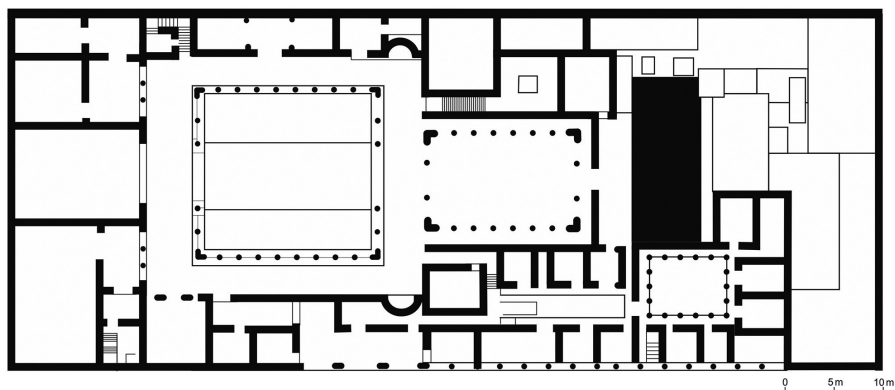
Planimetria del palazzo delle Colonne di Tolemaide, primo e secondo piano (disegno dell'autore).
